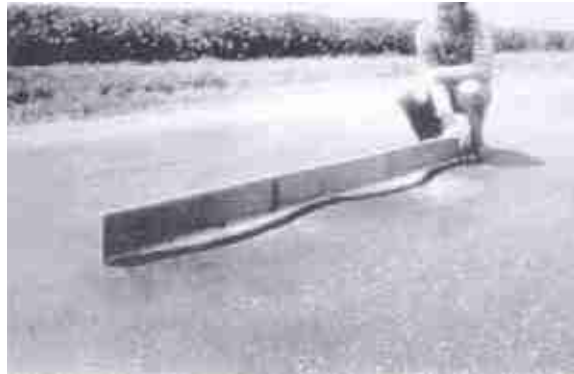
Falla Corrugación – Severidad Baja
